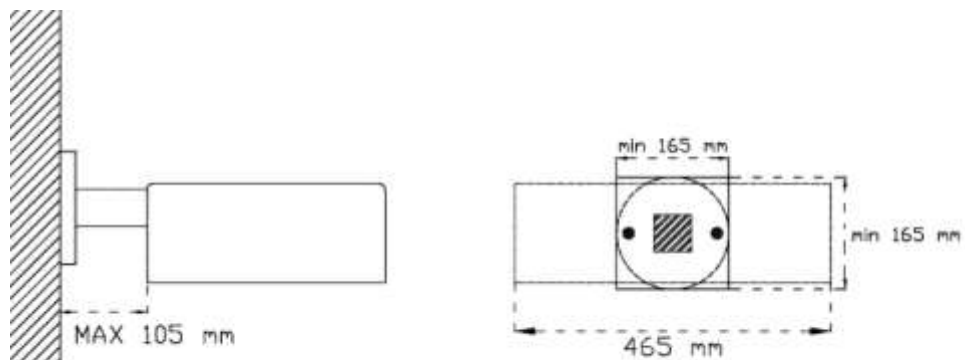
Apparecchi per fissaggio a parete per aree vincolate - Opzione 2 - Installazione tipica con staffa a muro dotata di codolo e snodo
